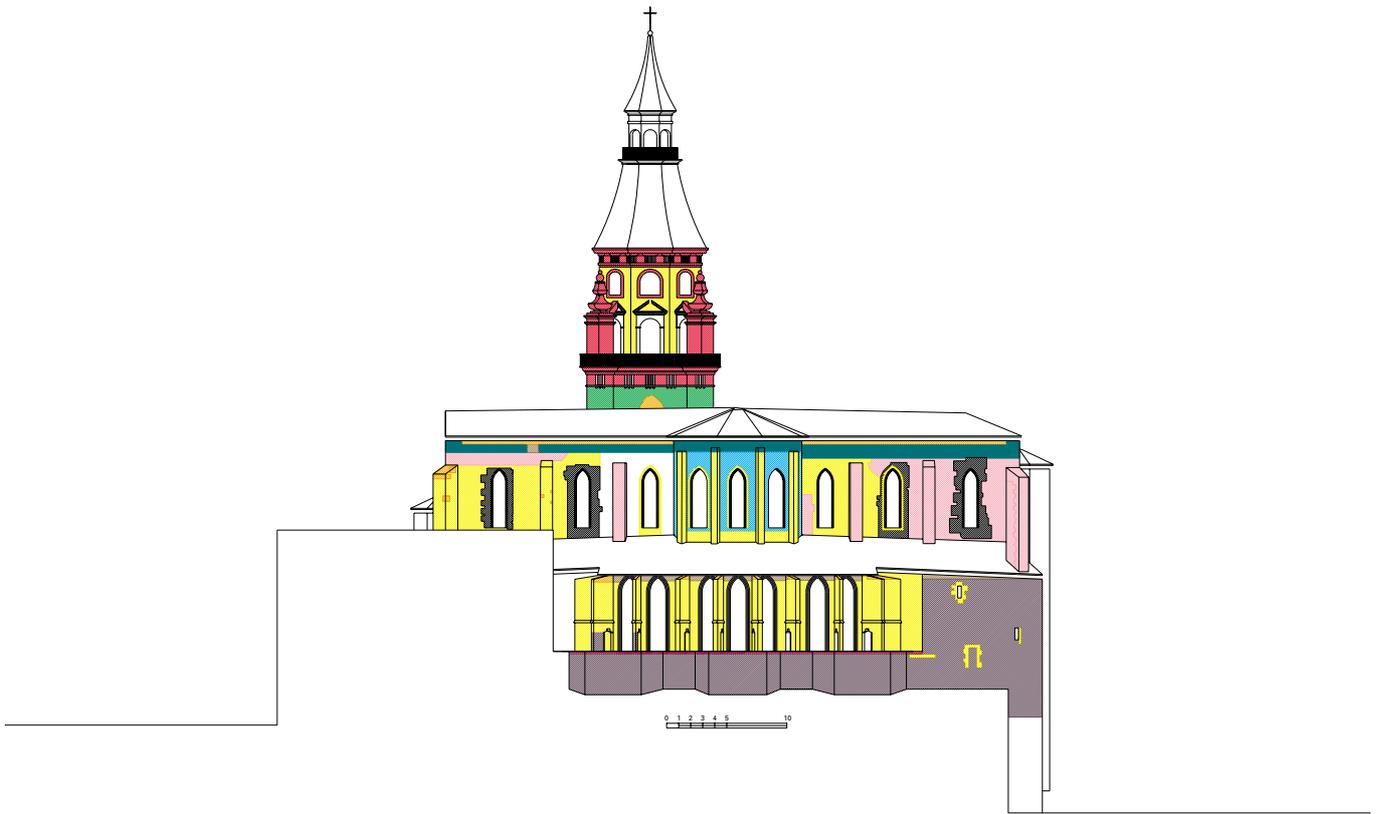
Distribución preliminar de tipos de fábrica. Fachada este
